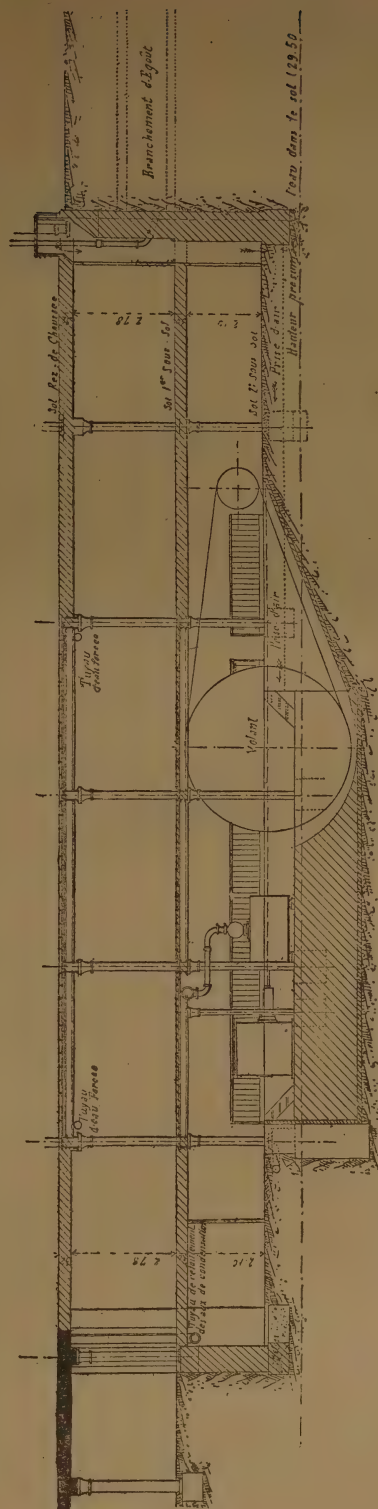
Fondations du Bon-Marché. — Coupe transversale montrant la vue de côté du caisson de la machinerie.
